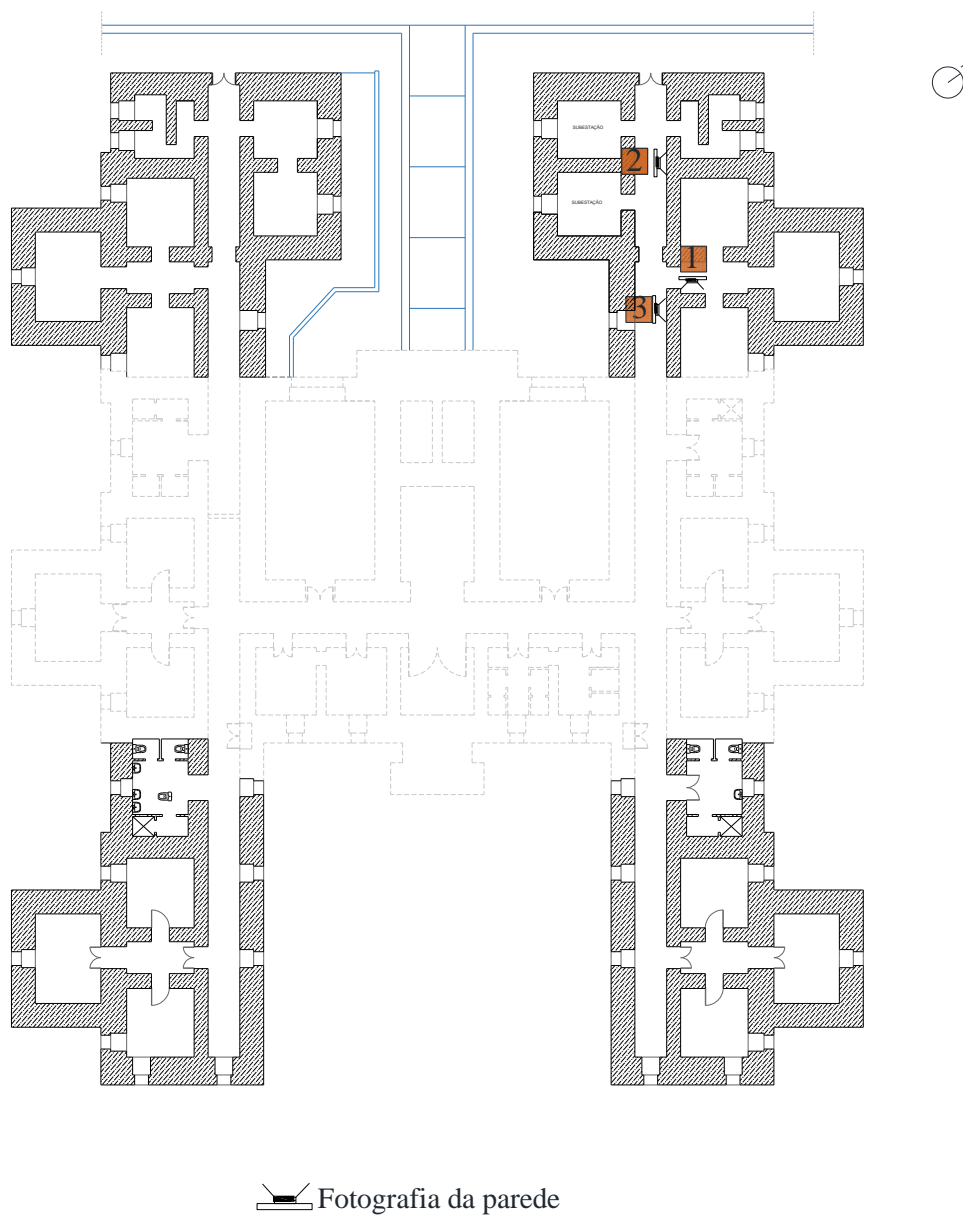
Localização das Imagens , na planta do Piso -1 [Fonte: Planta cedida pelo C.H.J.M]
